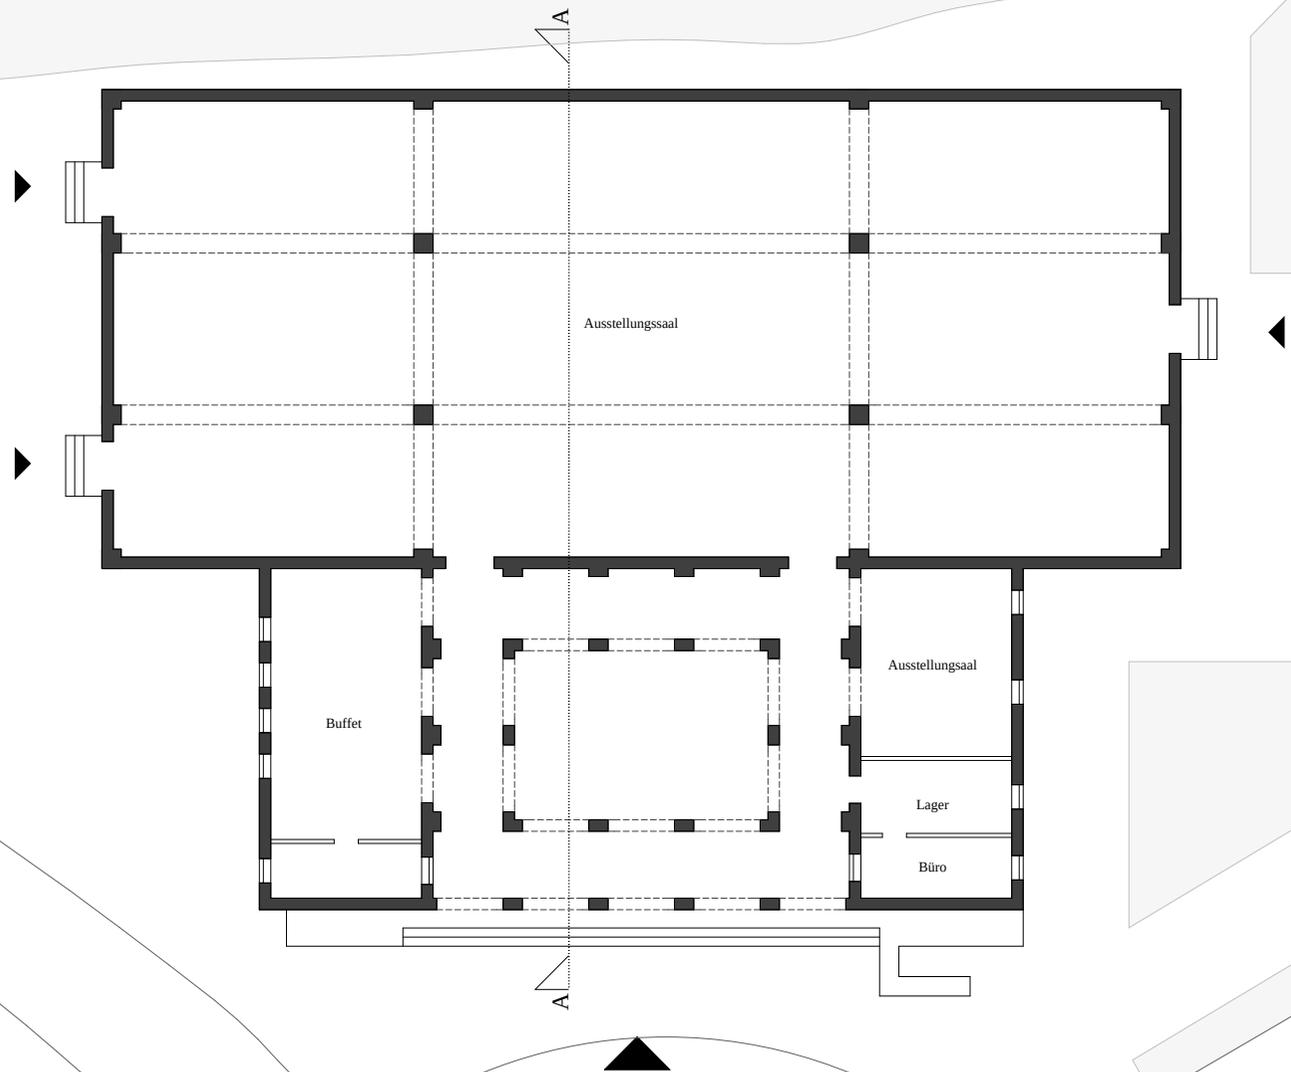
| Grundriss des ungarischen Pavillons
